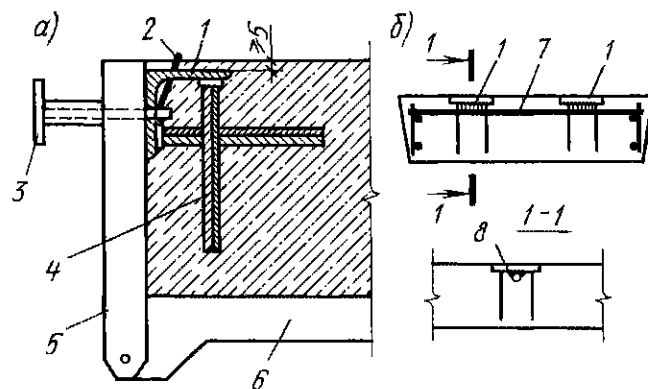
Примеры фиксации закладных деталей: а — к борту формы б — к арматуре; 1 — закладная деталь, 2 — шпунт в виде проволоки, выходящей на поверхность бетона (извлекают после уплотнения бетона); 3 — винтовой фиксатор, 4 — анкерующие стержни, 5 — борт формы; 6 — поддон формы, 7 — соединительный стержень, 8 — сварка.
